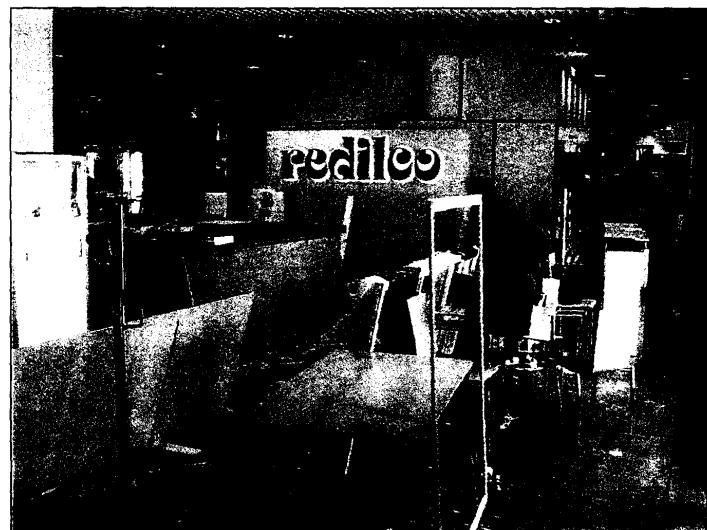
：展覽前夕展場內各攤位施工狀況（二）
